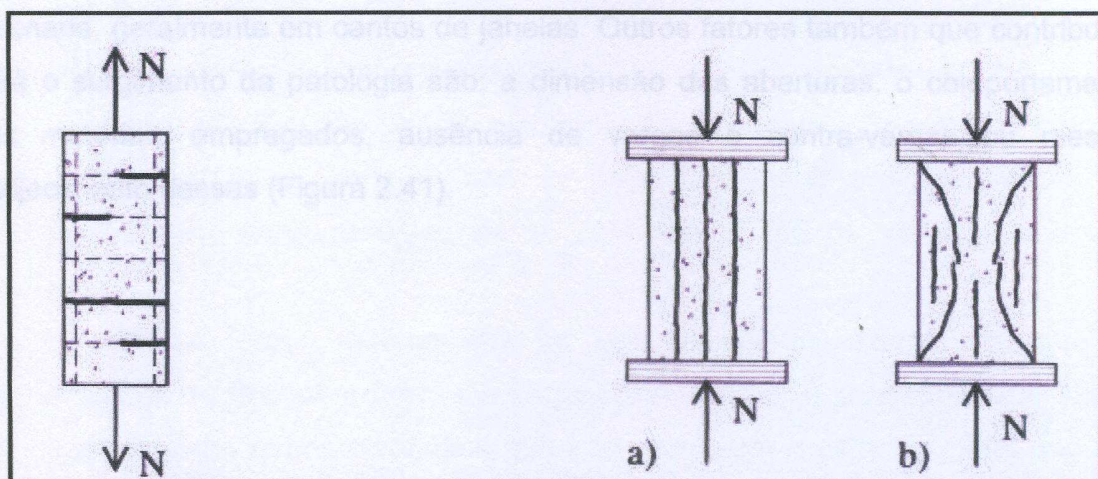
Representação esquemática de fissuração devido ao esforço de tração e compressão. (CANOVAS, 1988 *apud* BRANDÃO, 2007).
